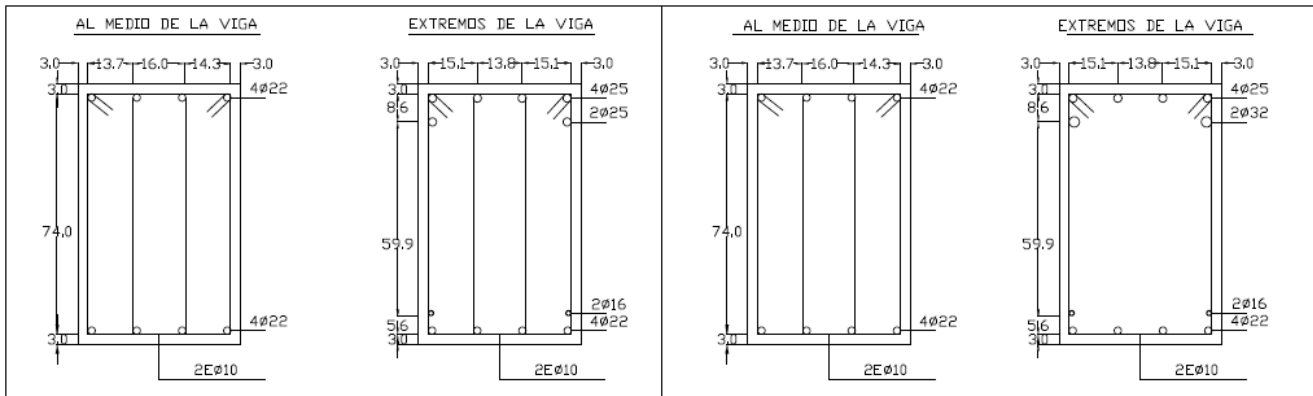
Sección transversal de las vigas del piso 2 del caso de estudio 2
